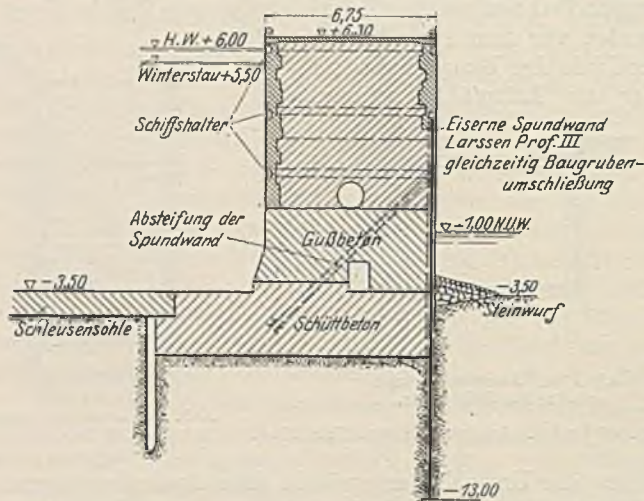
Querschnitt der Schleusenmauer der Hemelinger Schleuse als Beispiel der Verwendung von eisernen Spundwänden zur Baugrubenumschließung.
